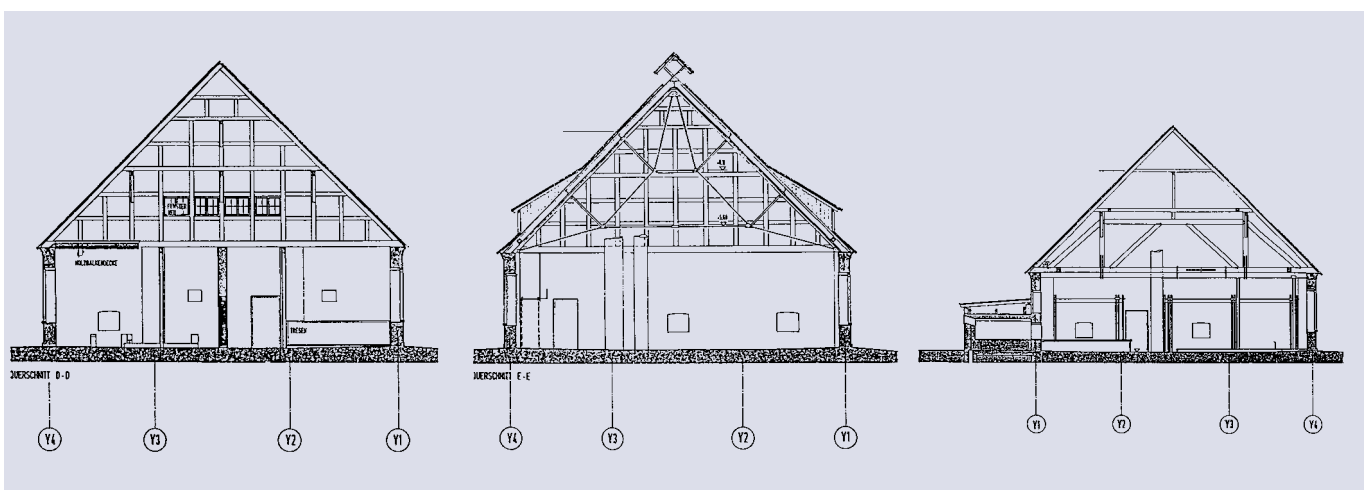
Querschnitt des Gebäudes, a) im Bereich der Fachwerkwand, b) im Bereich des Stahlbinders, c) im Bereich der Hängewerke, (Zeichnung: Architekt Dipl.-Ing. Ruprecht)
